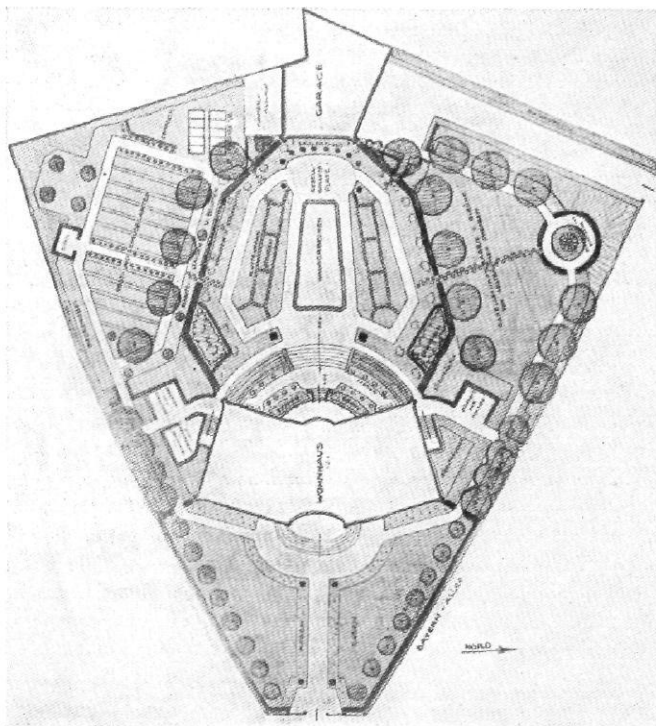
8 | Haus Westend | Maßstab der Grundrisse 1:300
